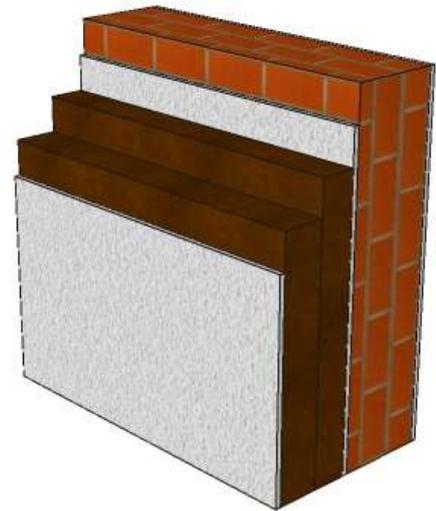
Holzfaser Platten gepresst und Profiliert von Pavatherm
